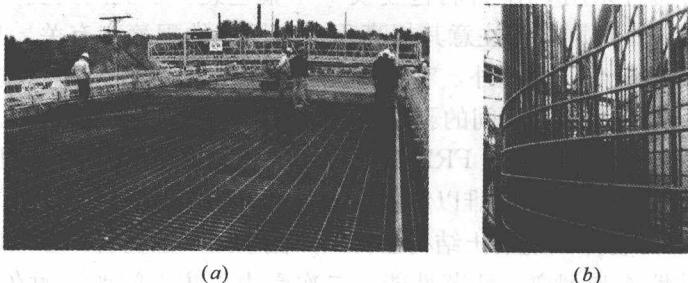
FRP配筋混凝土在桥梁和建筑中的应用
